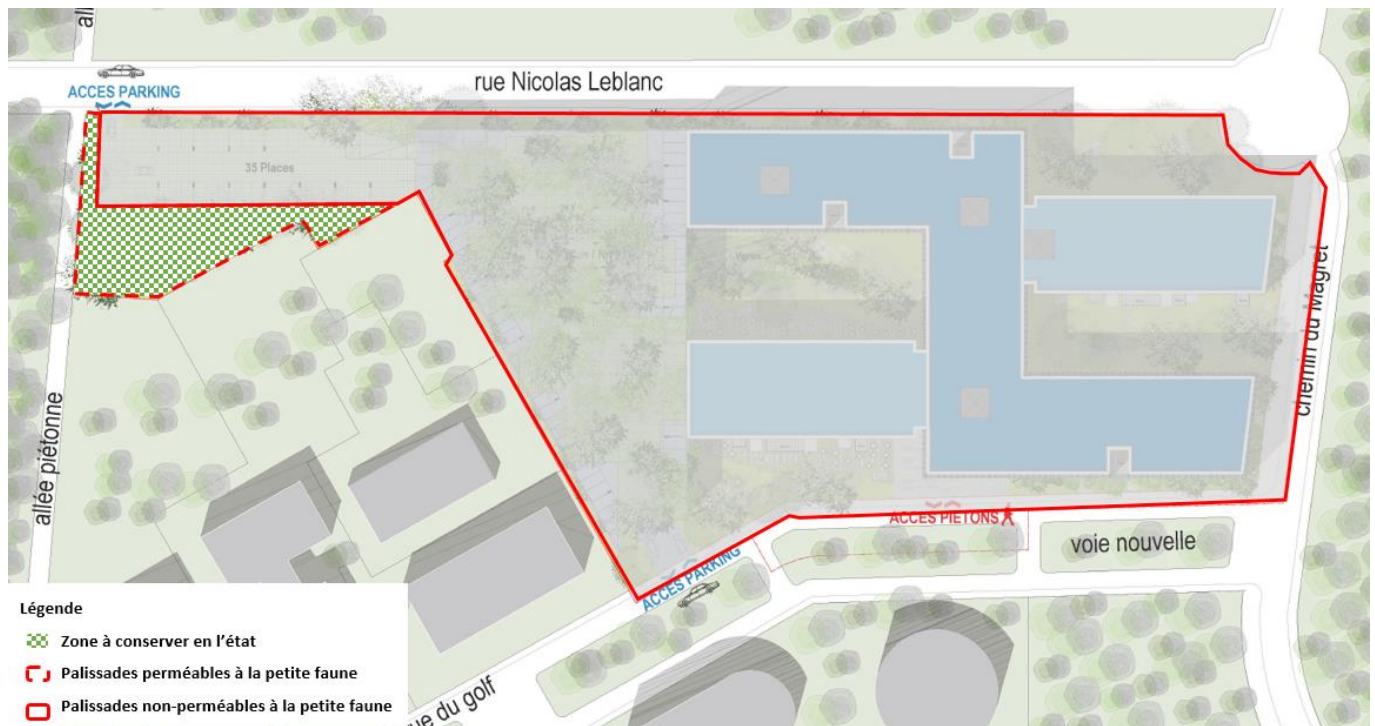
Palissades perméables et non-perméables à la petite faune à mettre en place sur le projet avant le début des travaux.
